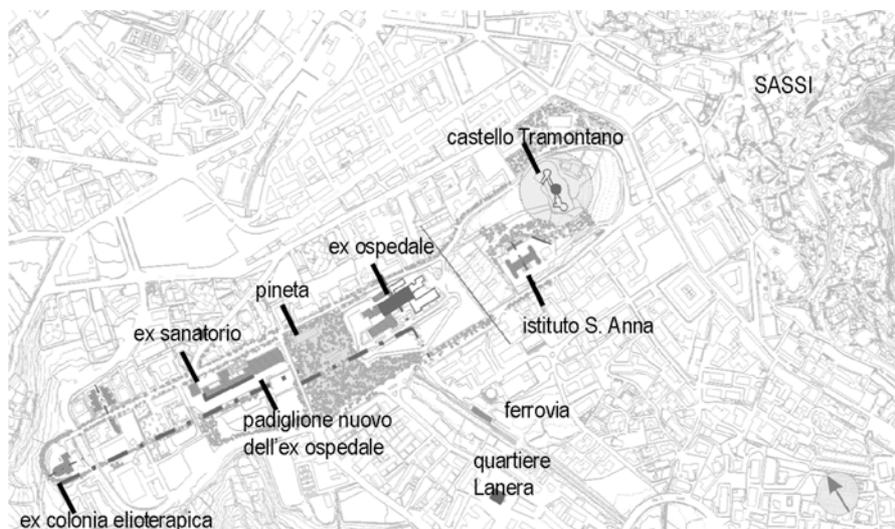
planimetria dell'area di intervento, in evidenza gli edifici oggetto del progetto
